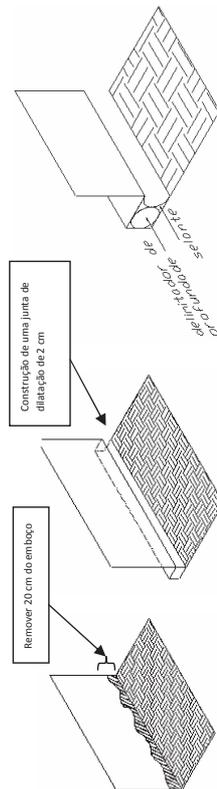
Propostas para execução de junta de dilatação entre o piso do passeio e a parede da edificação.
